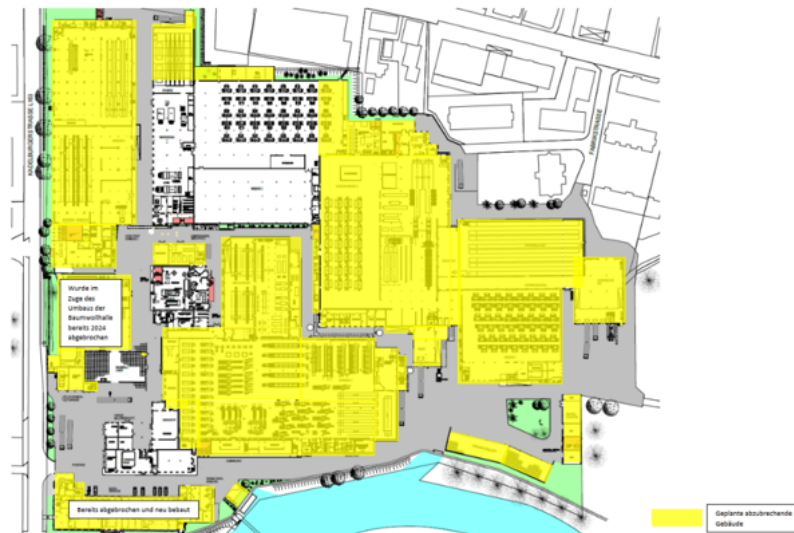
Abbruchplan der Gemeinde Lauchringen – Rückbaugebäude gelb markiert.
